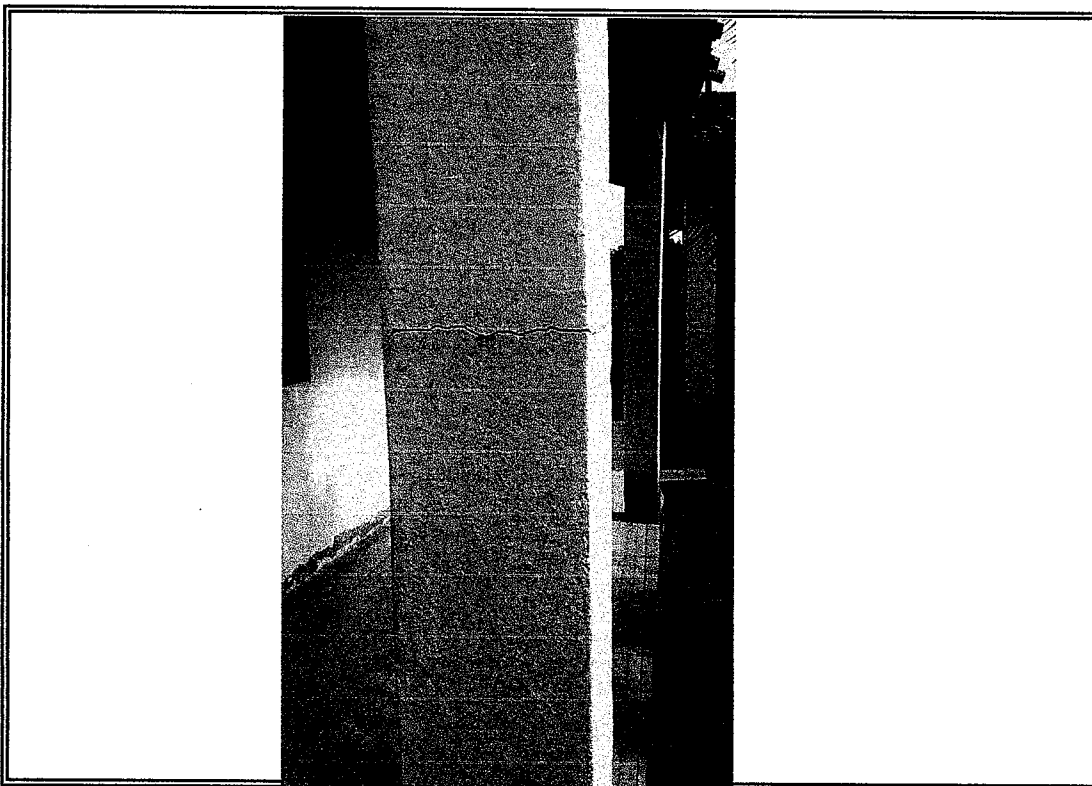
Vista do local receberá novo pilar, devido a falta de resistencia do pilar existente que apresnetou flambagem.
